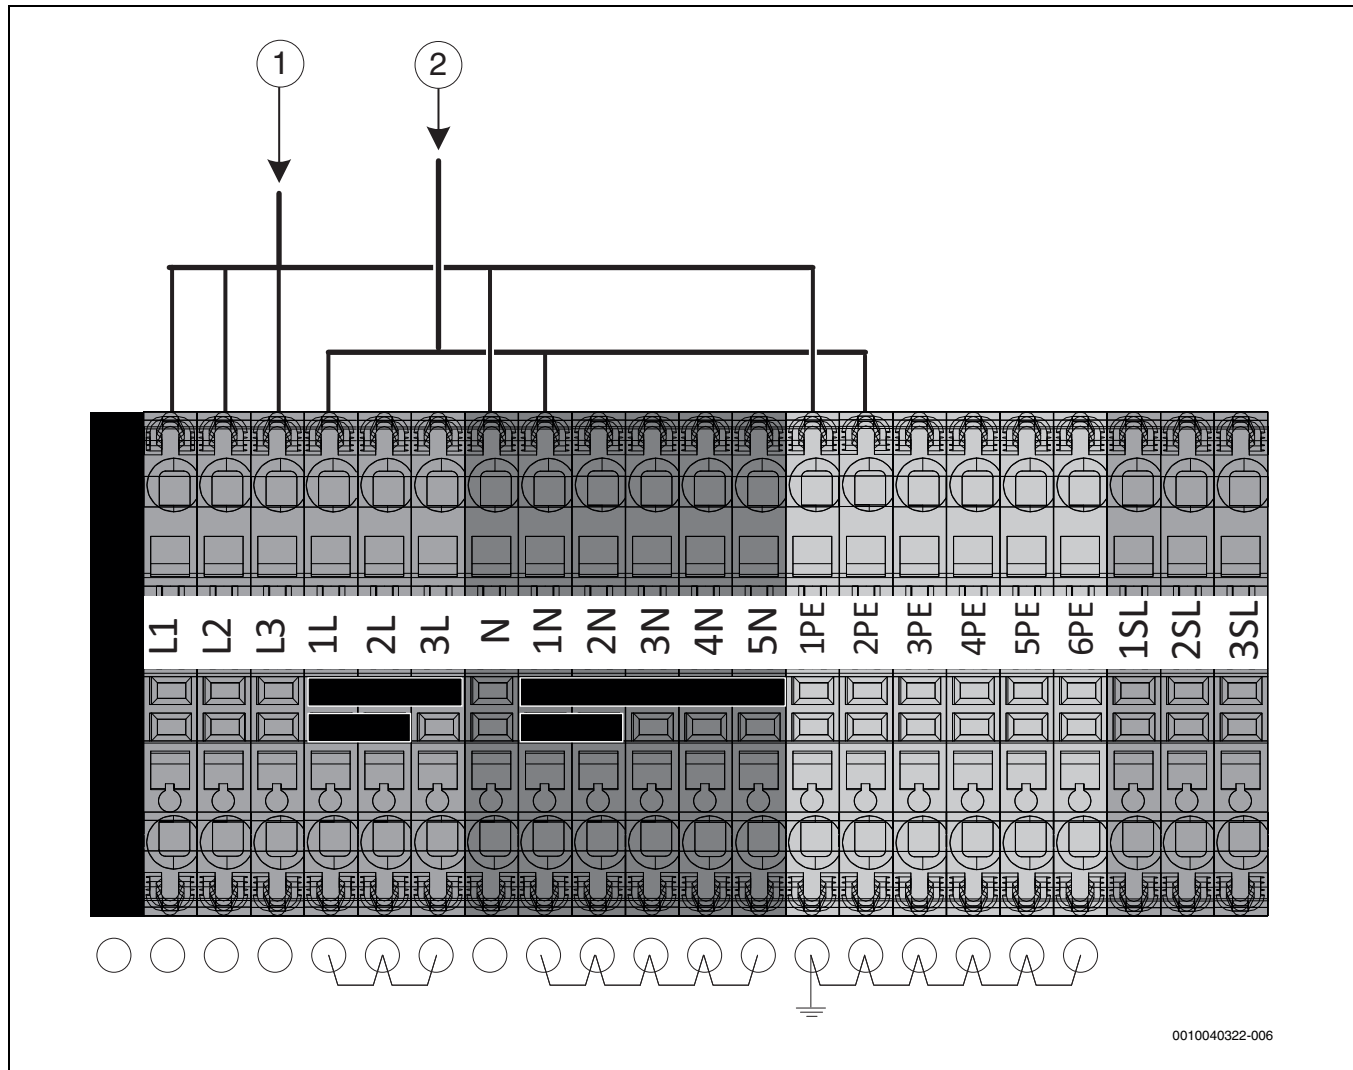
Collegamenti elettrici con disabilitazione EVU
